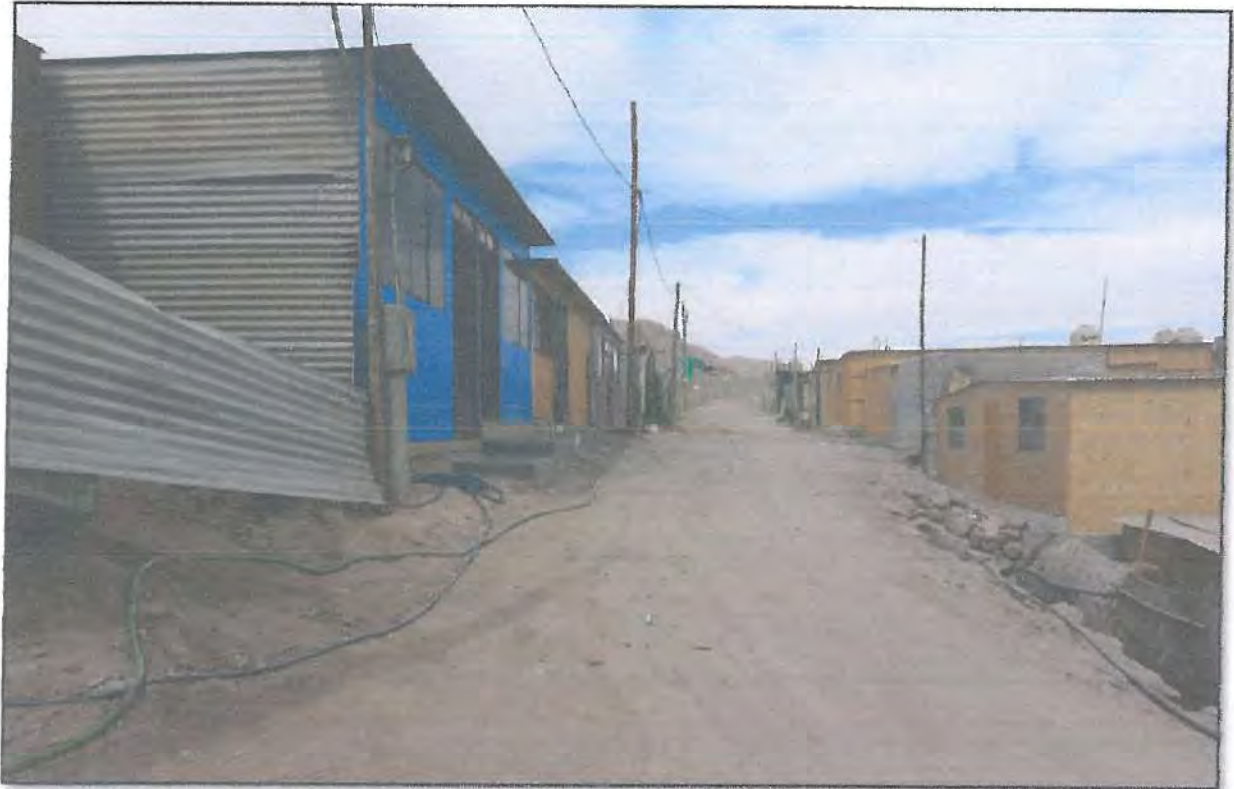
Vista de la Calle N° 07 entre la manzana A y la asociación de vivienda Santa Fe de Monterrey
